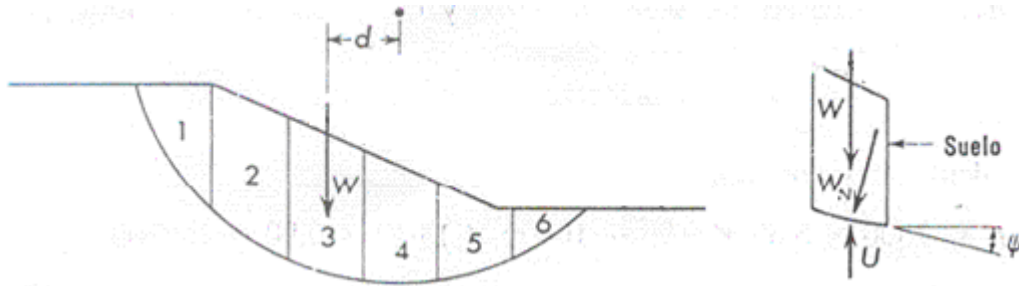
(sección y forma de las dovelas y rebanadas de un talud)
